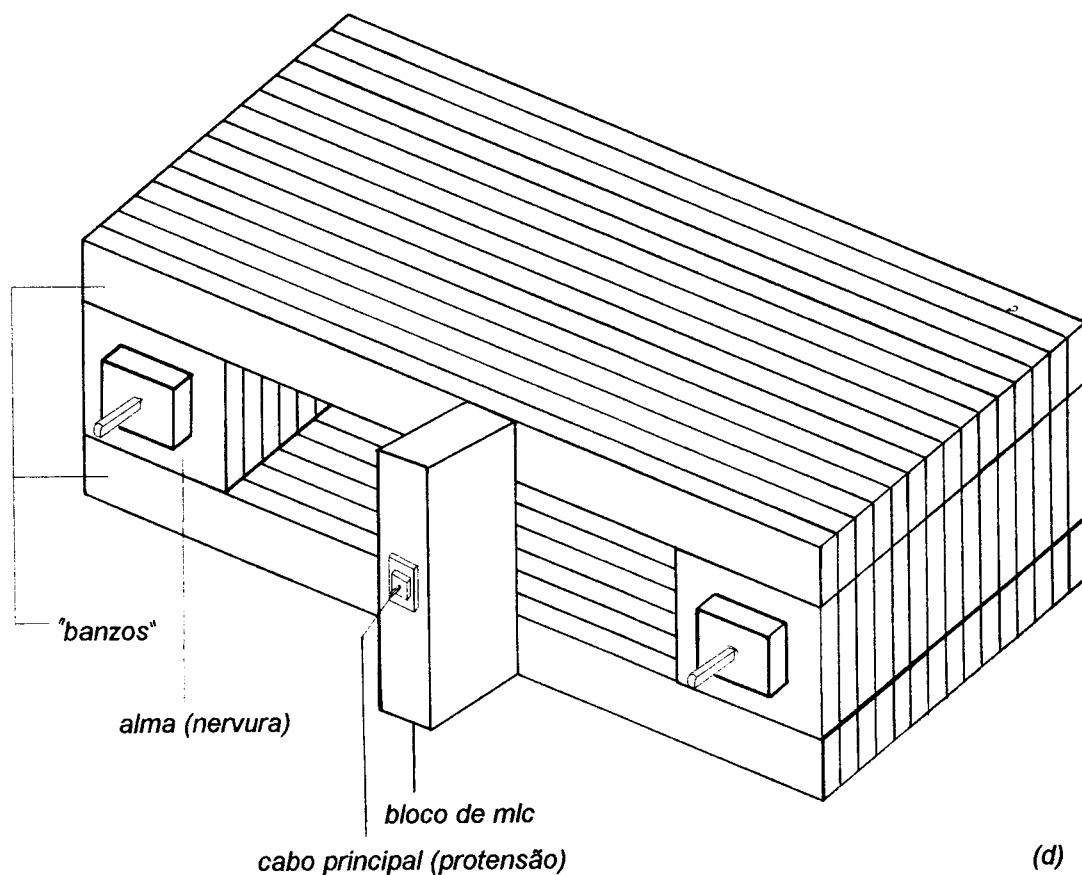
Aspectos principais da Hiroshima Bridge : Vistas das vigas laminadas.
